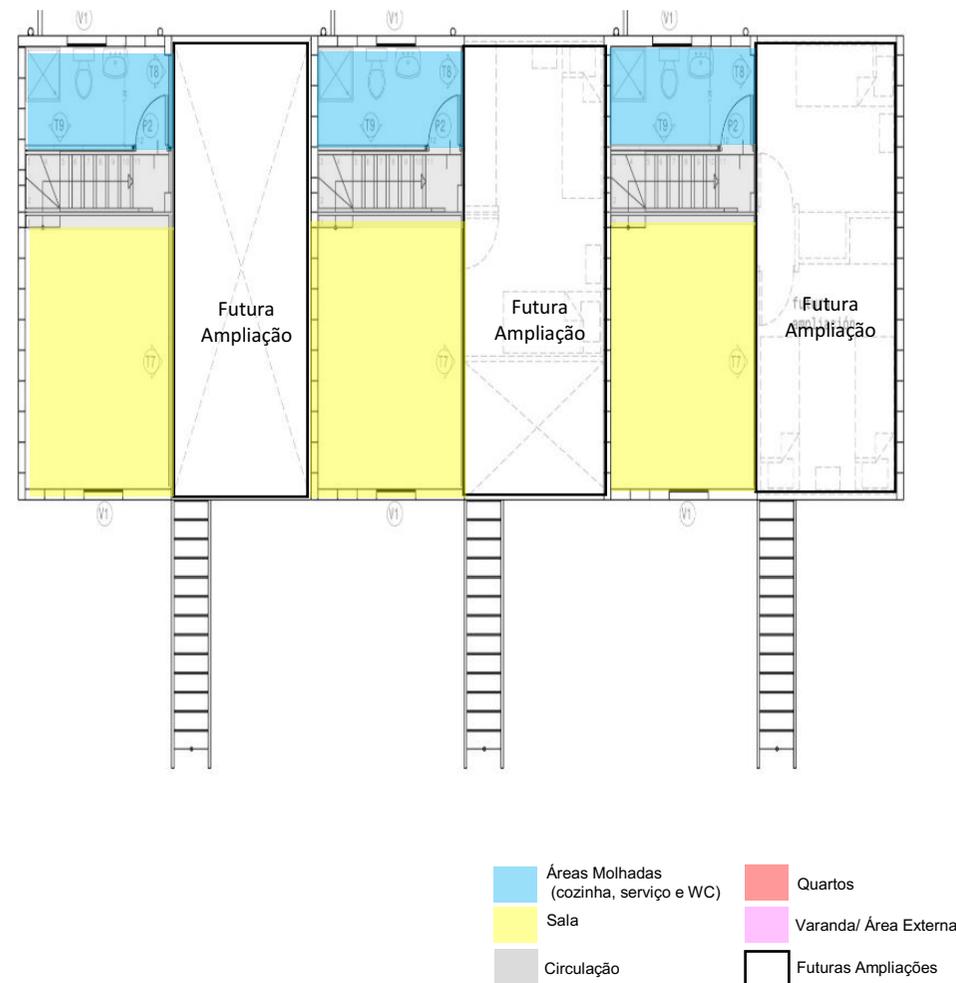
Zoneamento da projeção segundo pavimento.(Fonte: Archidaily)
